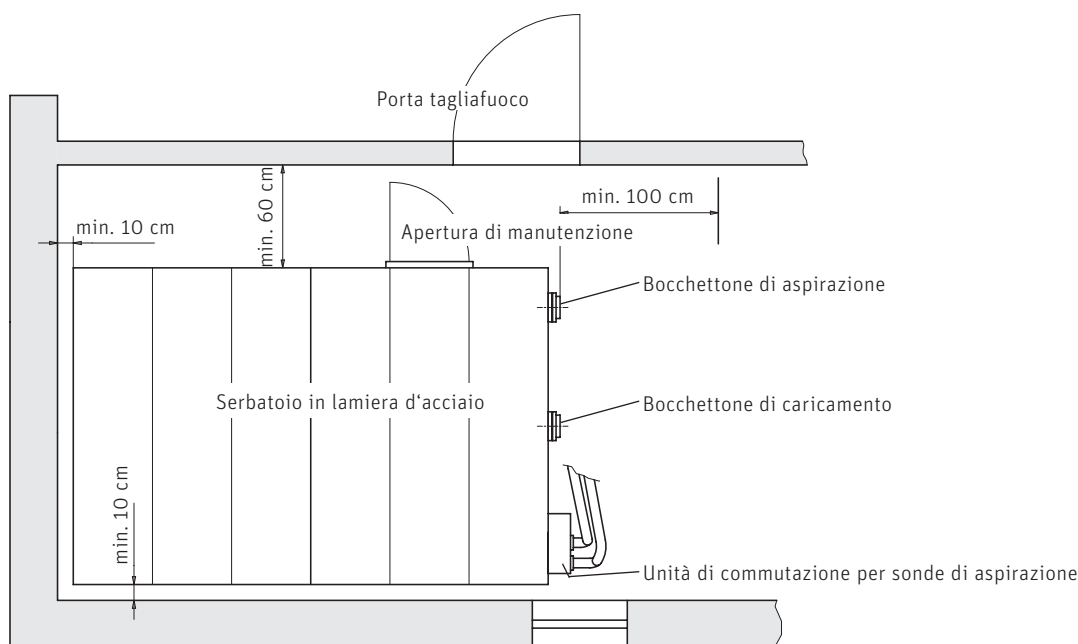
Serbatoio in lamiera d'acciaio e locale caldaia – vista dall'alto
